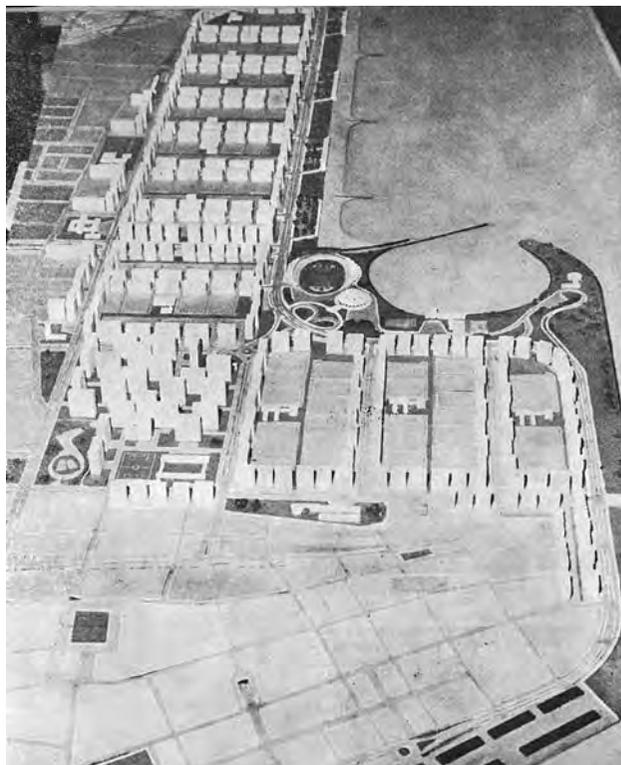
maquete do projeto para a Praia de Belas – Plano de 1959/61.
